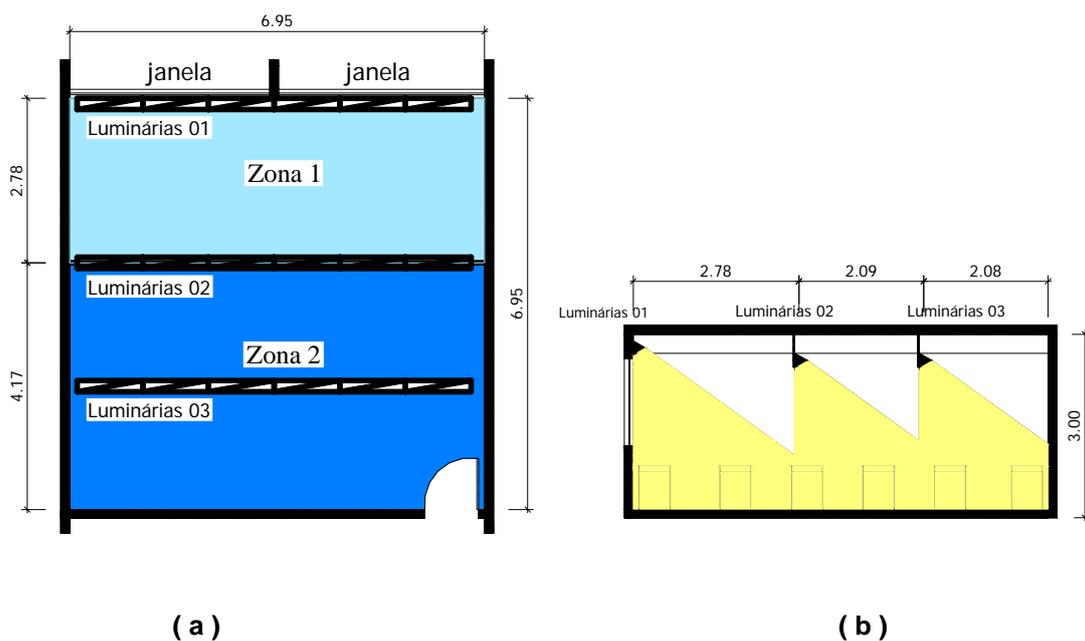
Planta baixa (a) e Corte (b) com localização de luminárias.
